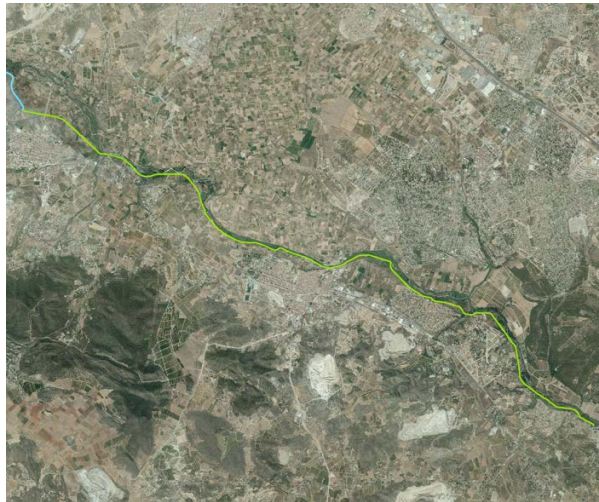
Planta Tubería Captación 1 (Plano 03111. Captación 1. Planta General)
